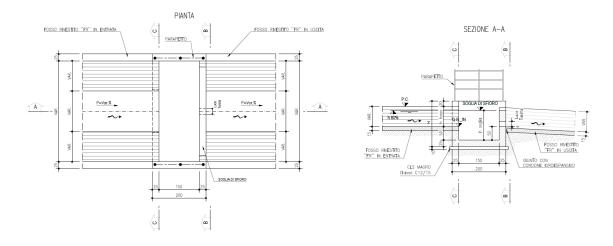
Sezione tipologica dei manufatti di regolazione tipo "MC1"
